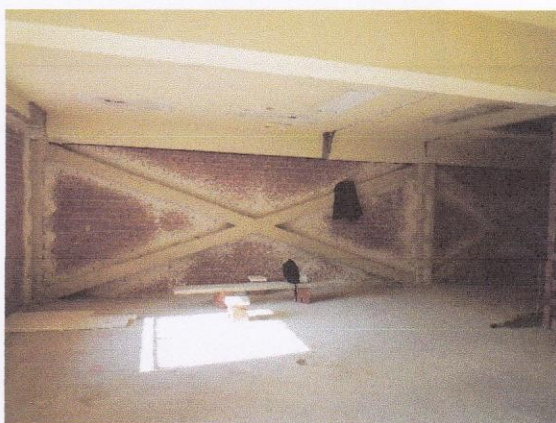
y 9 (20/01/11): reparación del frente de los forjados de la fachada interior del edificio T.
